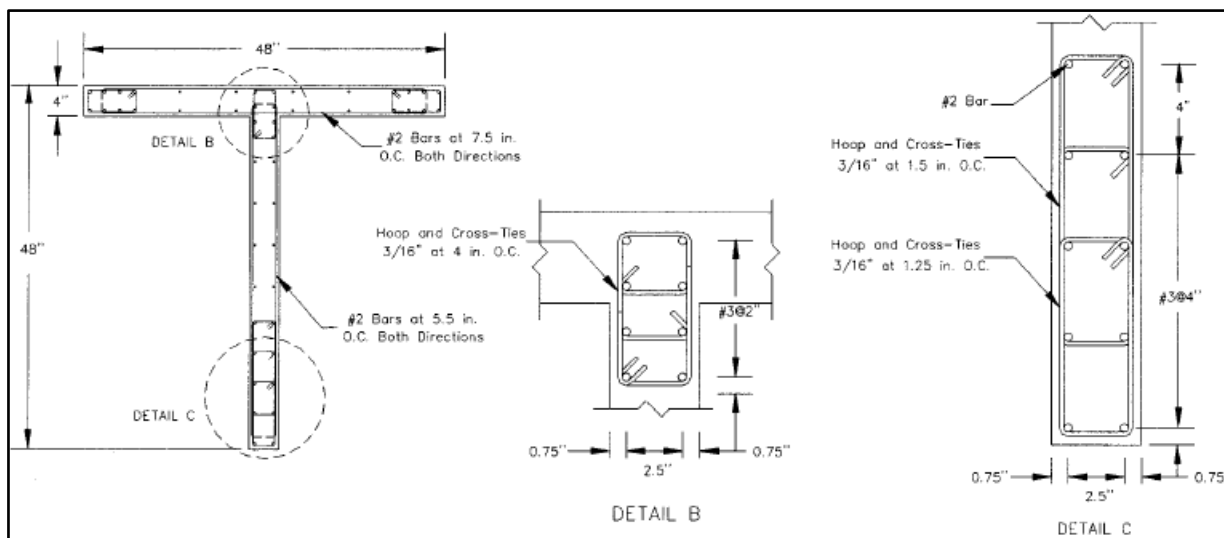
Detalles del armado del muro TW2 (desde Thomsen y Wallace [38]).
